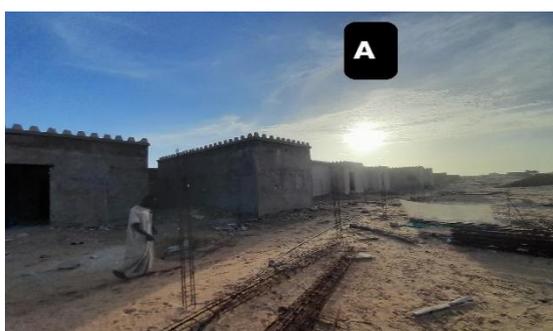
Blocs traversés par la ligne 1 (Rosso-Mderdra-R'kz)
